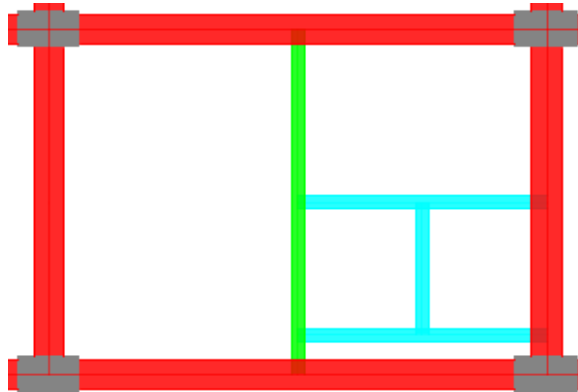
Vigas correspondientes al bloque de las escaleras de la Estructura A
